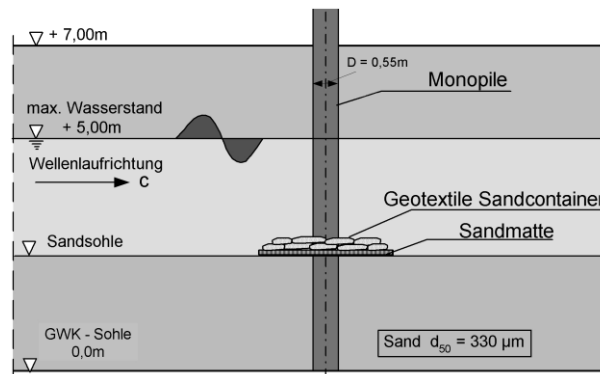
Schema einer Kolkicherung mit Geotextilen Sandcontainern und Modell-Aufbau für großmaßstäbliche Untersuchungen im GWK
